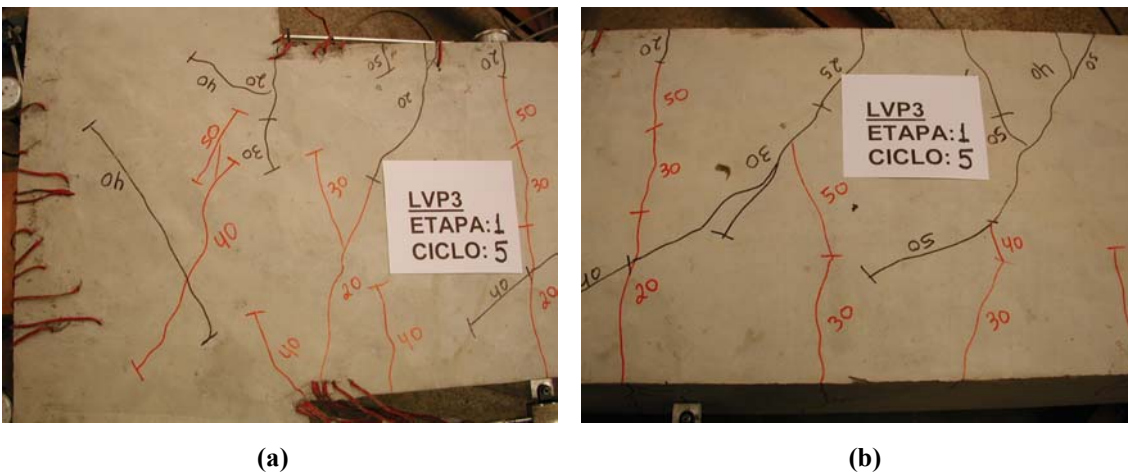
Detalhe das fissuras do pórtico de Alva, $F = \mp 50\text{KN}$: (a) nó, (b) viga
